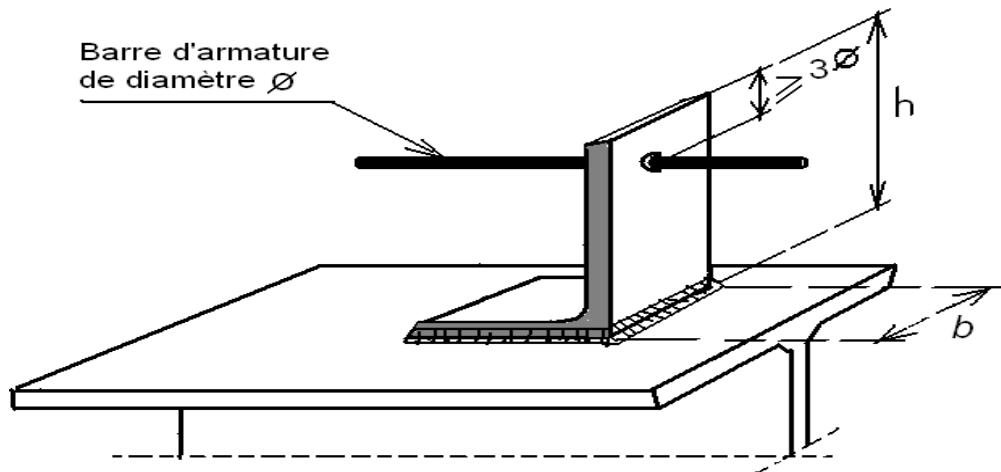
Dimensions d'une cornière soudée avec filant
